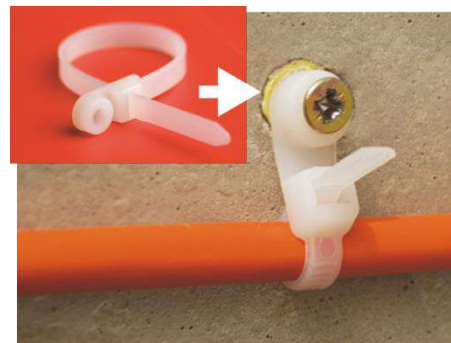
Монтаж ЧЭ ProCab® на стене.
